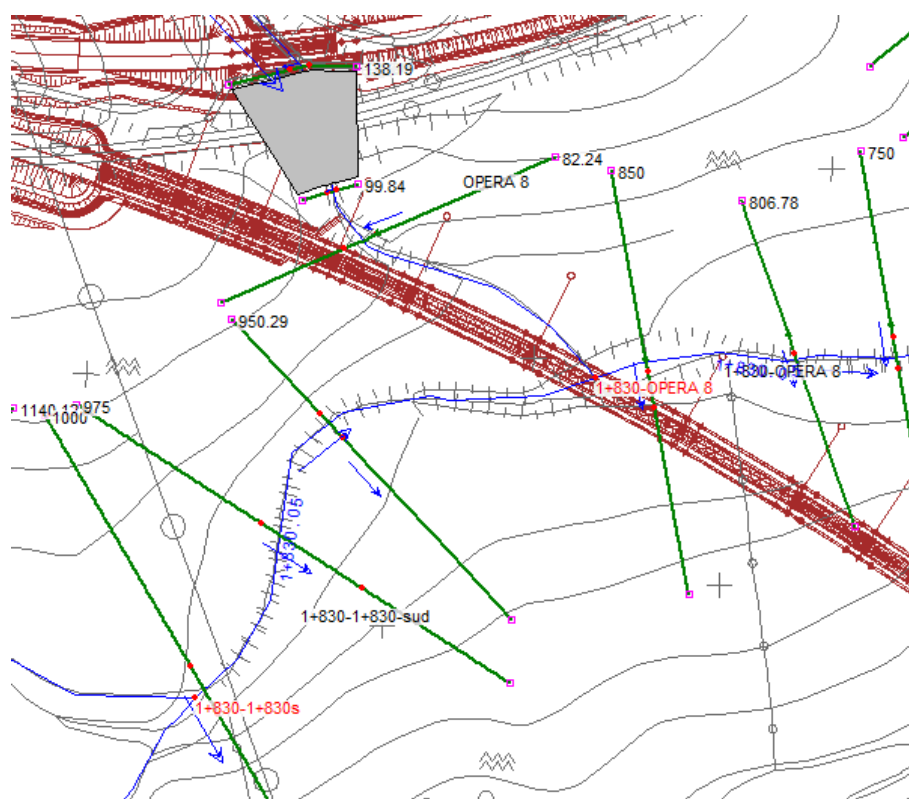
Planimetria Hec ras – sovrapposizione SDF – linea di progetto
